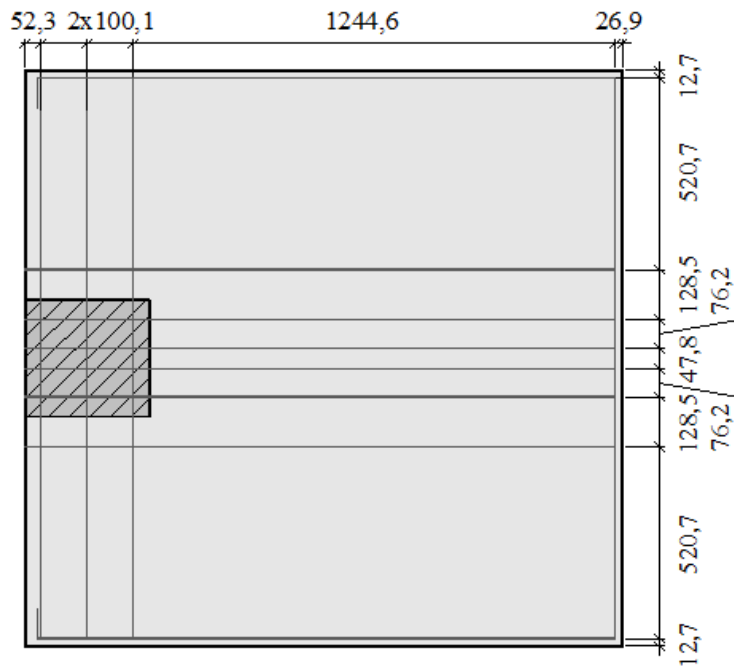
Posicionamento da armadura tracionada nas lajes S1 a S4 – Foutch (1990)
